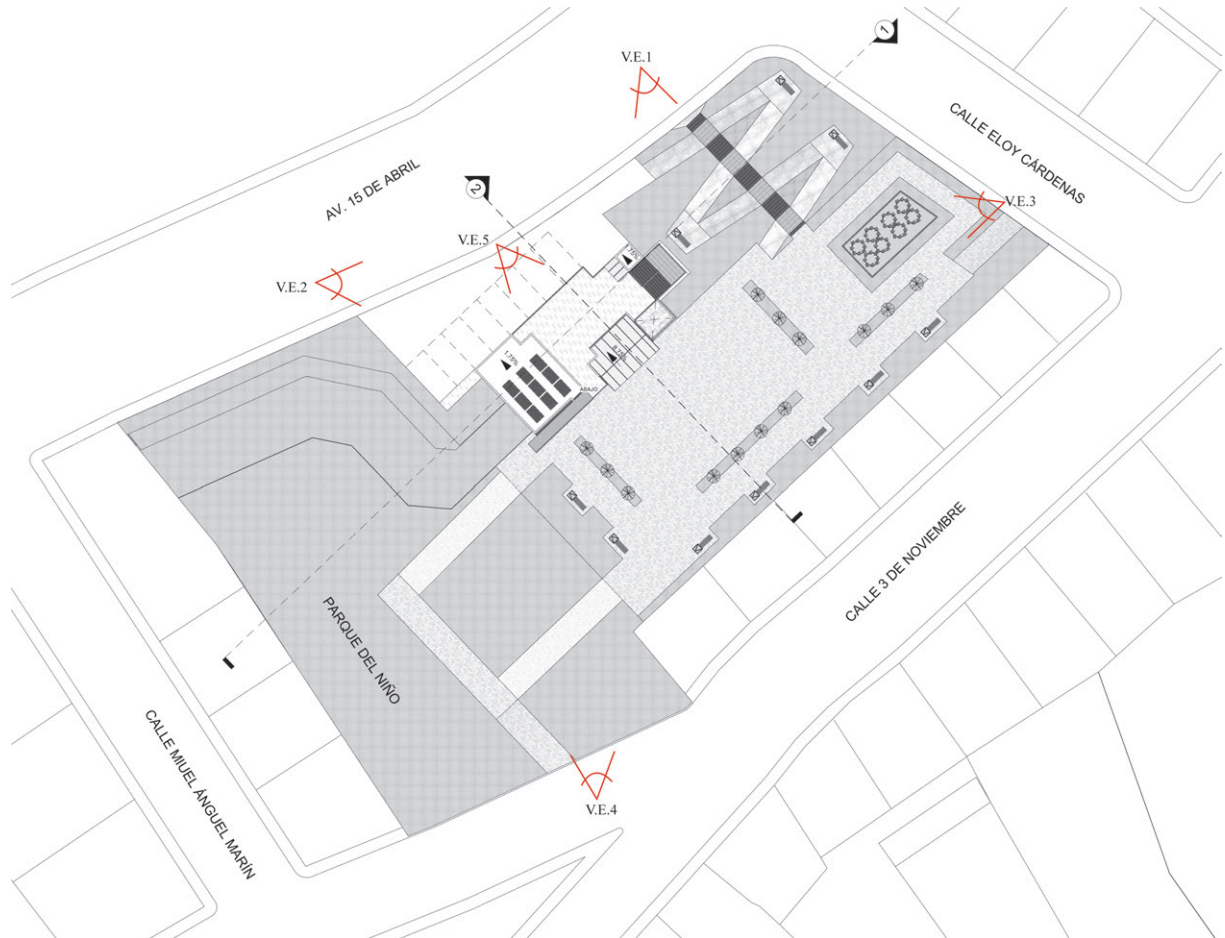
Ubicación de los ángulos de las vistas exteriores. Fuente y elaboración: Autor.
